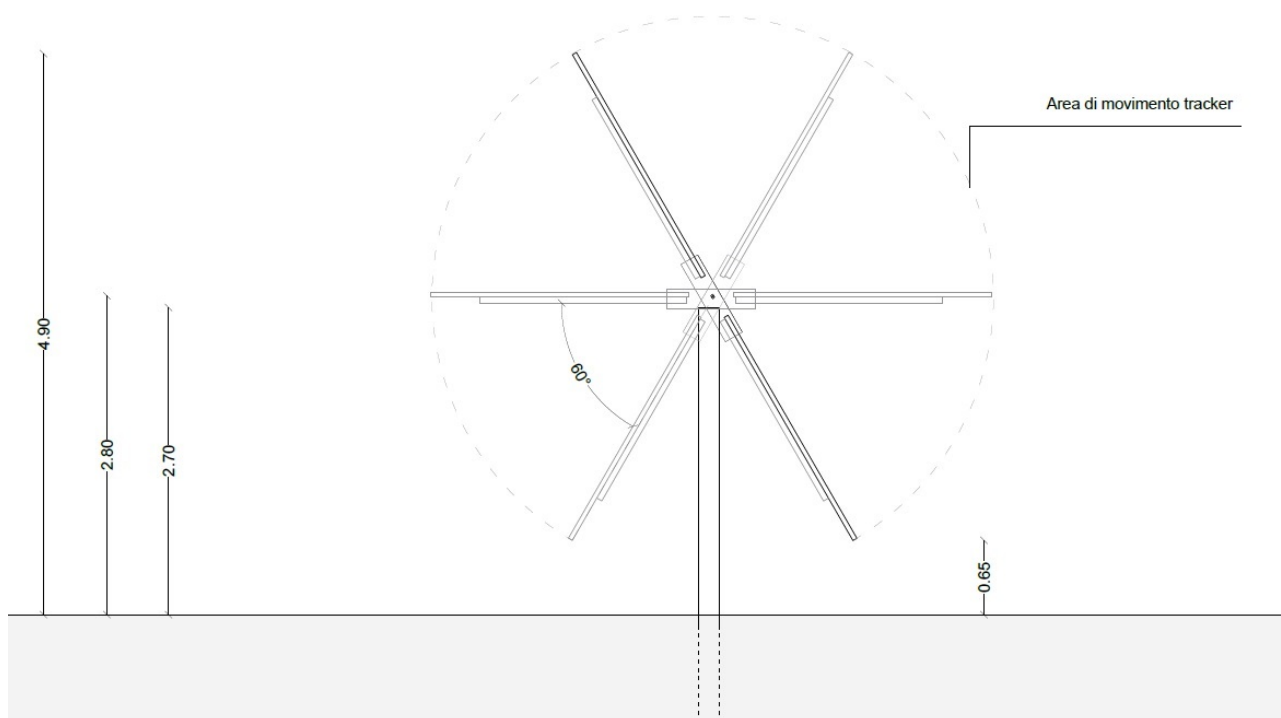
Strutture di sostegno e sistema di inseguimento solare
